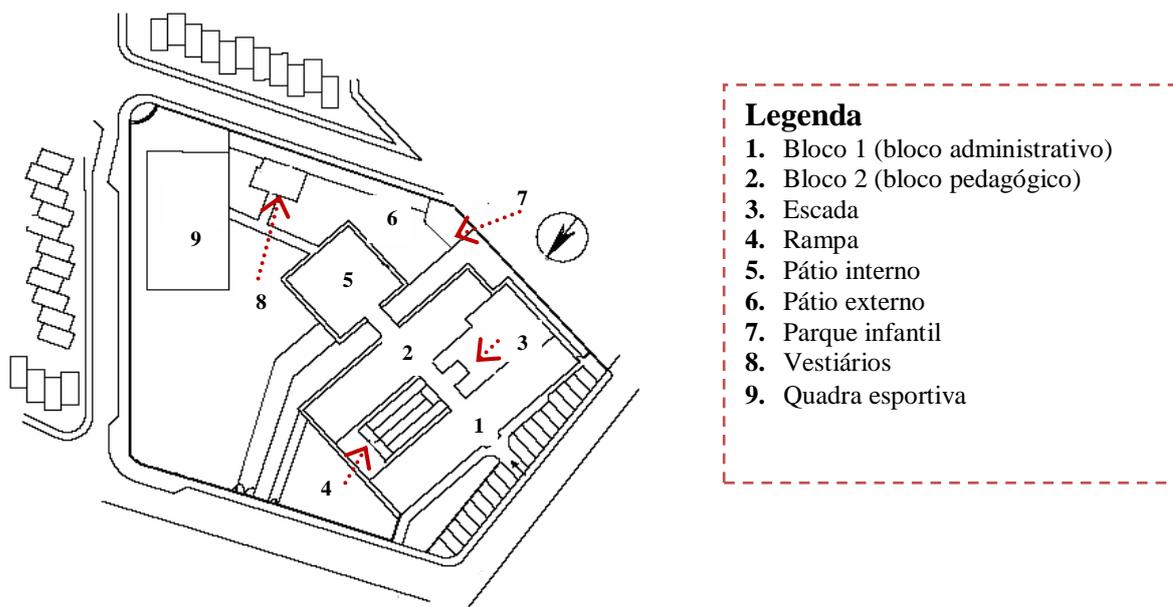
Croqui da planta baixa da Escola Básica Donícia Maria da Costa
